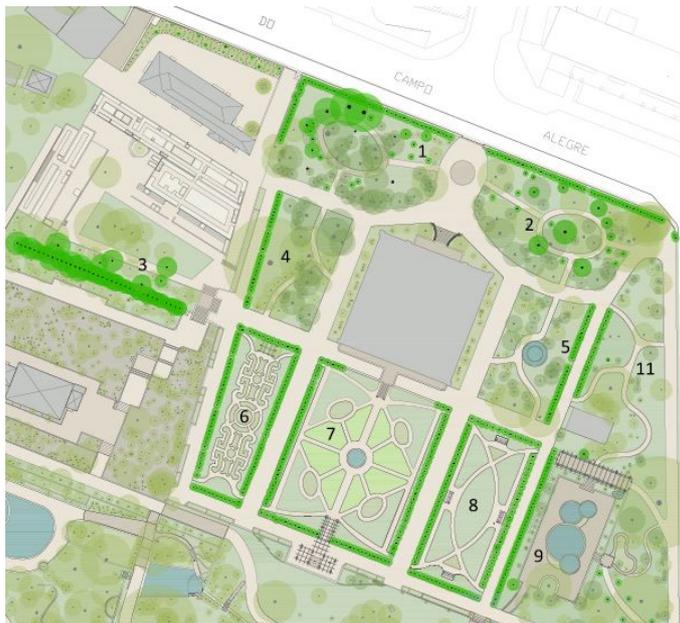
Parcela do Plano Geral da Situação Existente no JBP:
